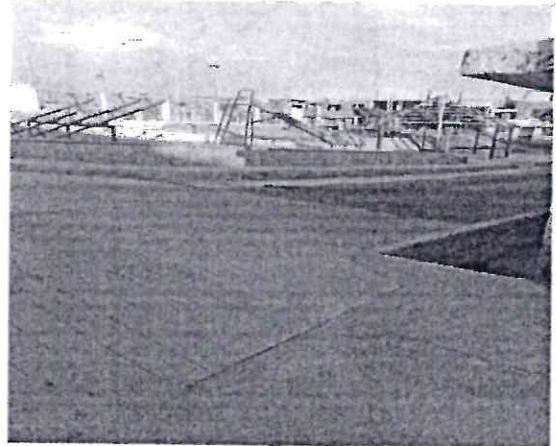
Se aprecia la construcción de una rampa vehicular y un drenaje de tubería en la av. Necochea intersección Pasaje San Pedro (Cte. 27).
